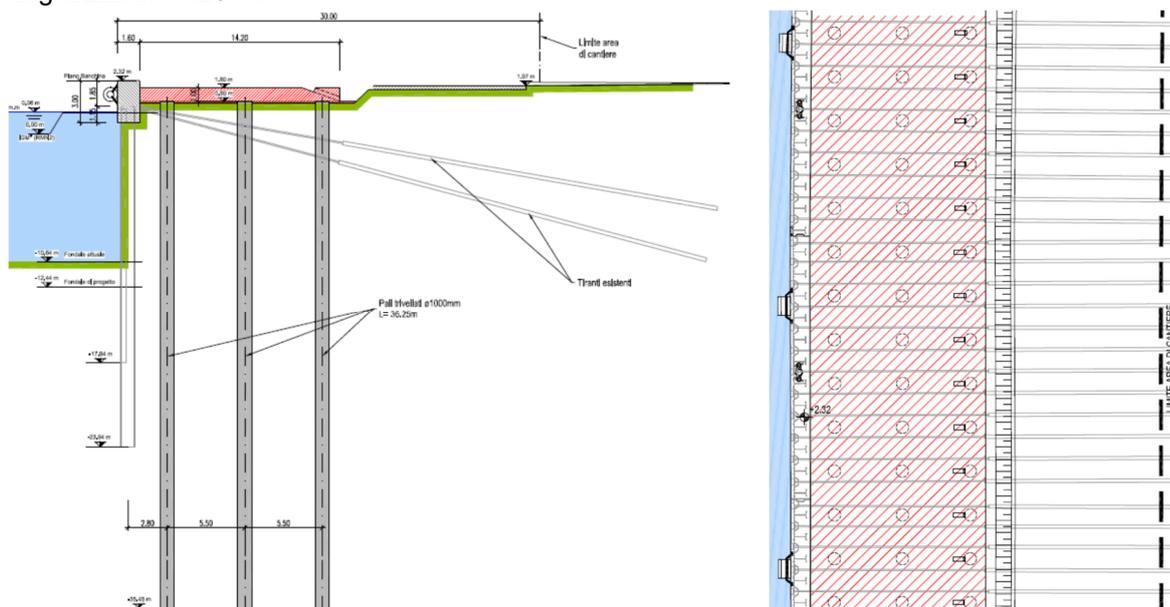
Banchina Trattaroli Nord – Fase 6 – Sezione e planimetria
